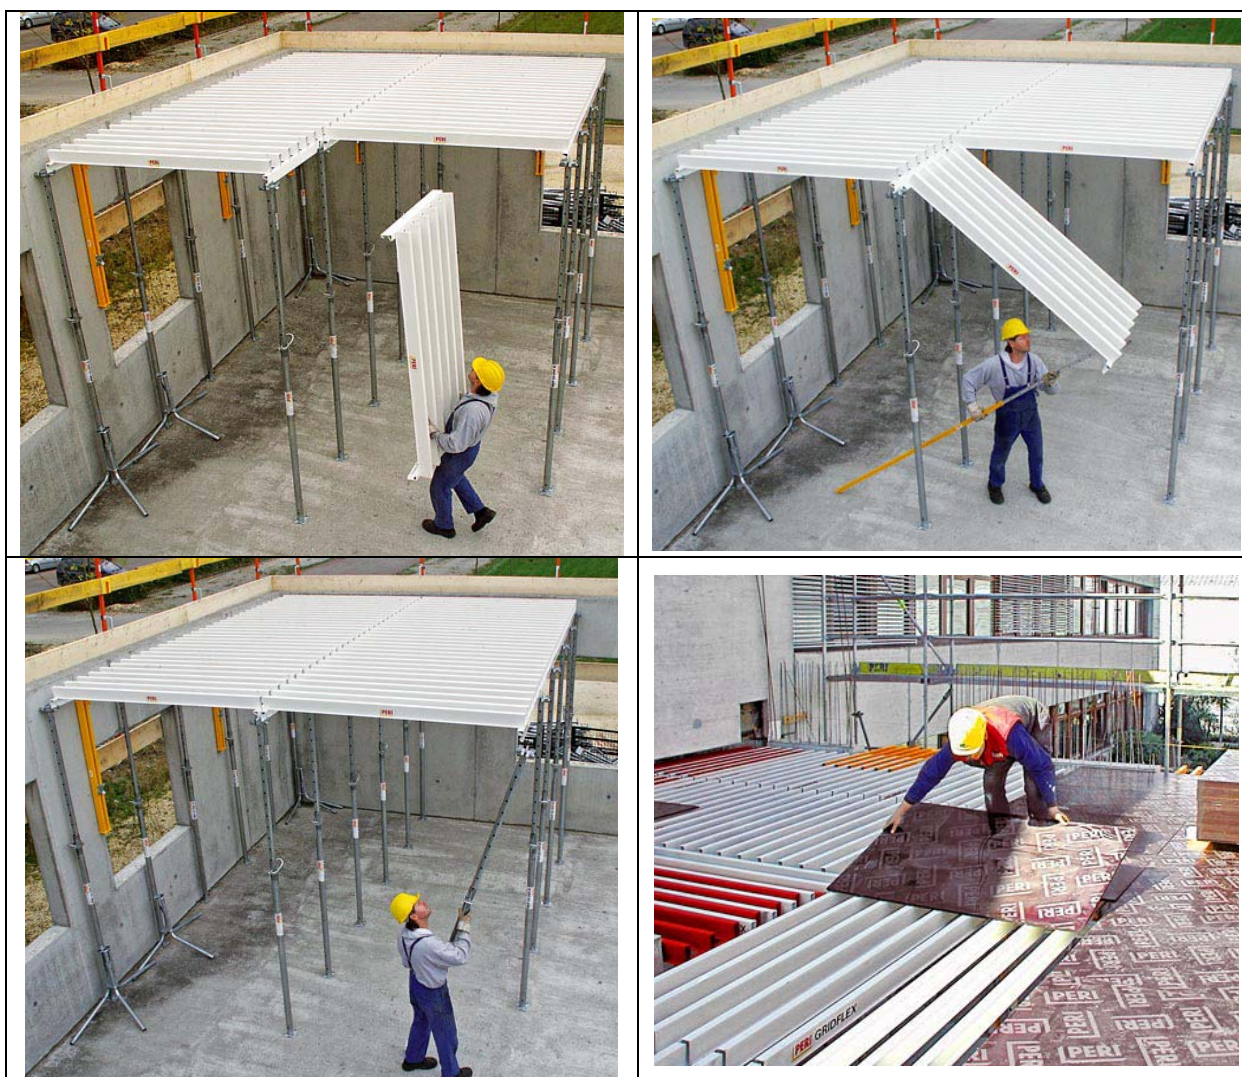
Impiego di solai a travetti in grado di adattarsi alla configurazione planimetrica dell'edificio.
